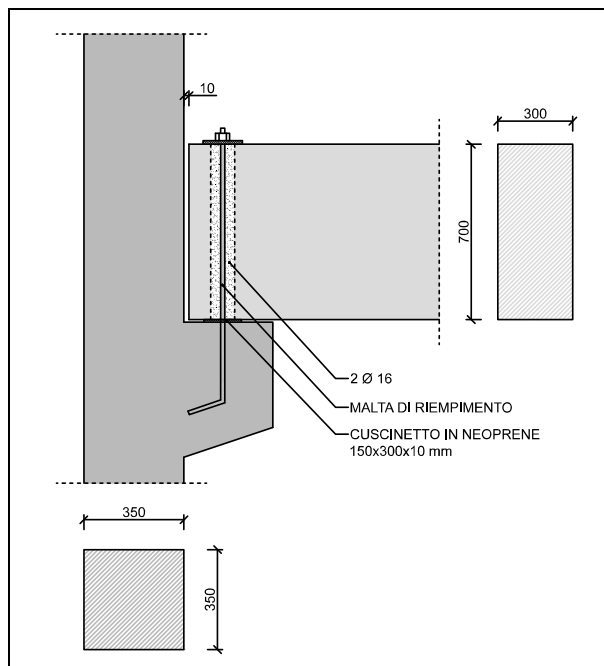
Dettaglio della connessione trave-pilastro considerata.
